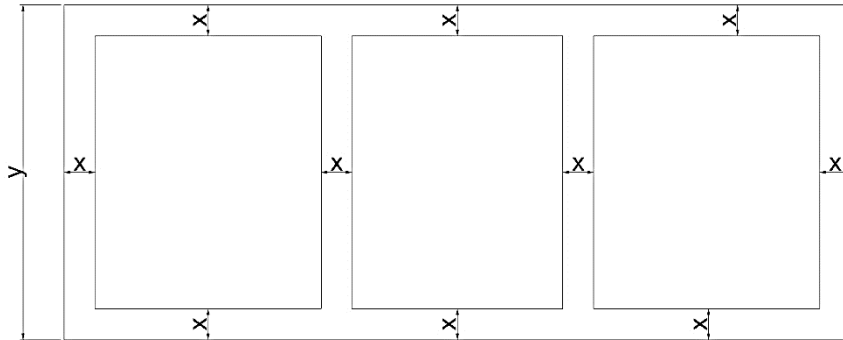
2. Üst yapı ön cam boyut hesabı grasshopper yapılanması
